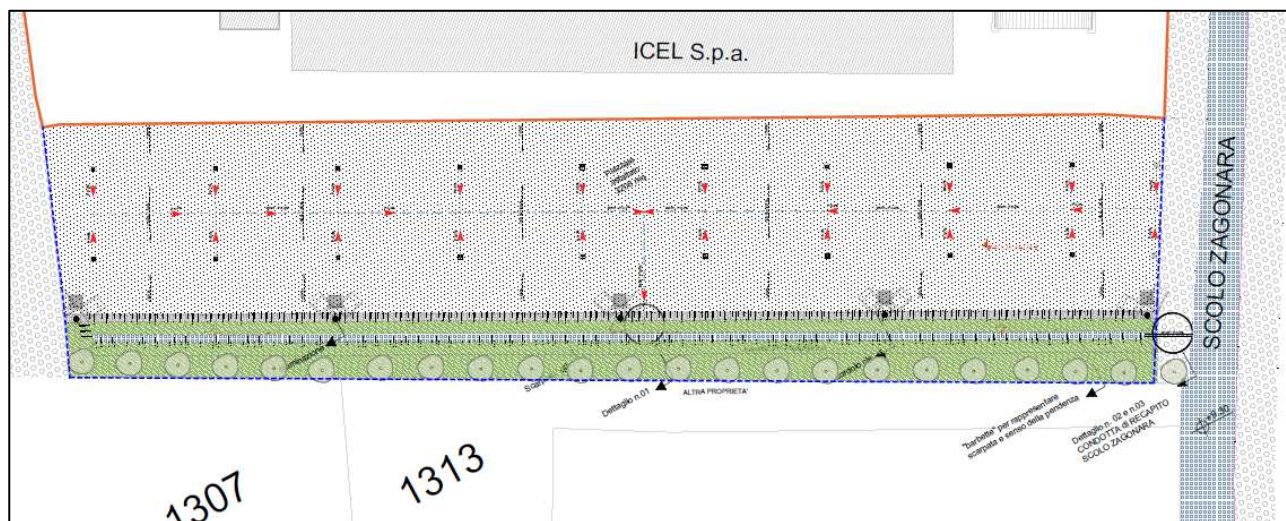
Stralcio tratto dalla Planimetria C23182-ARC-20250624-Base-AR_03.pdf
